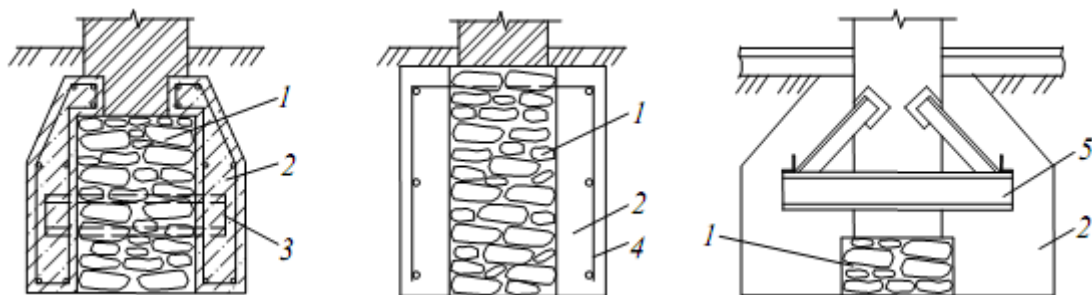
Варіанти посилення бутових і бутобетонних фундаментів:
